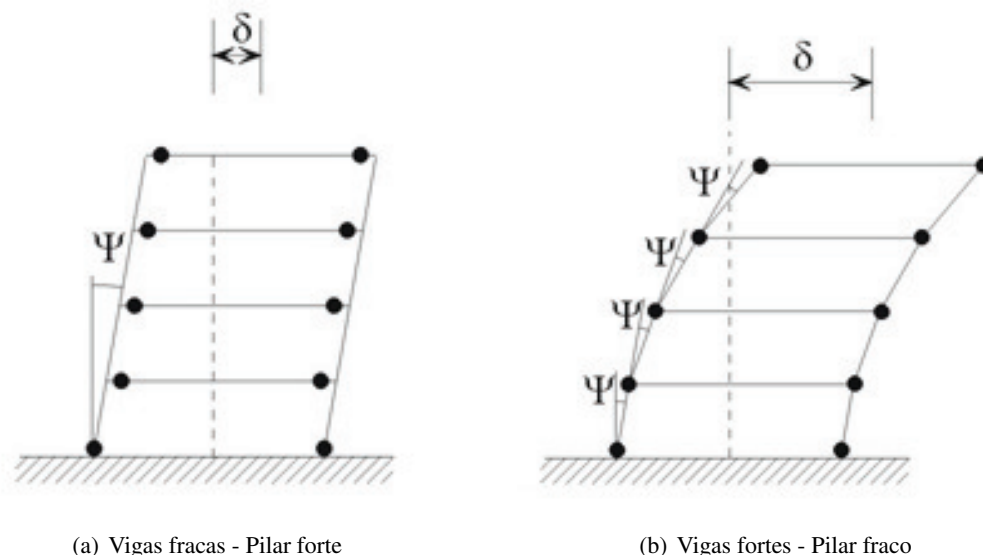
Utilização de vigas fortes - pilar fraco versus vigas fracas - pilar forte (Neves e Branco, 2010)
